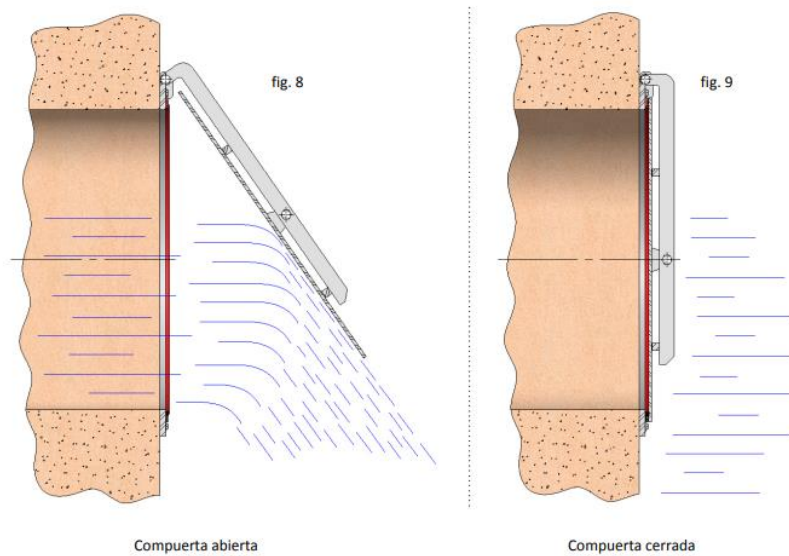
, compuerta de clapeta. Fuente: [www.cmovalves.com](http://www.cmovalves.com)
